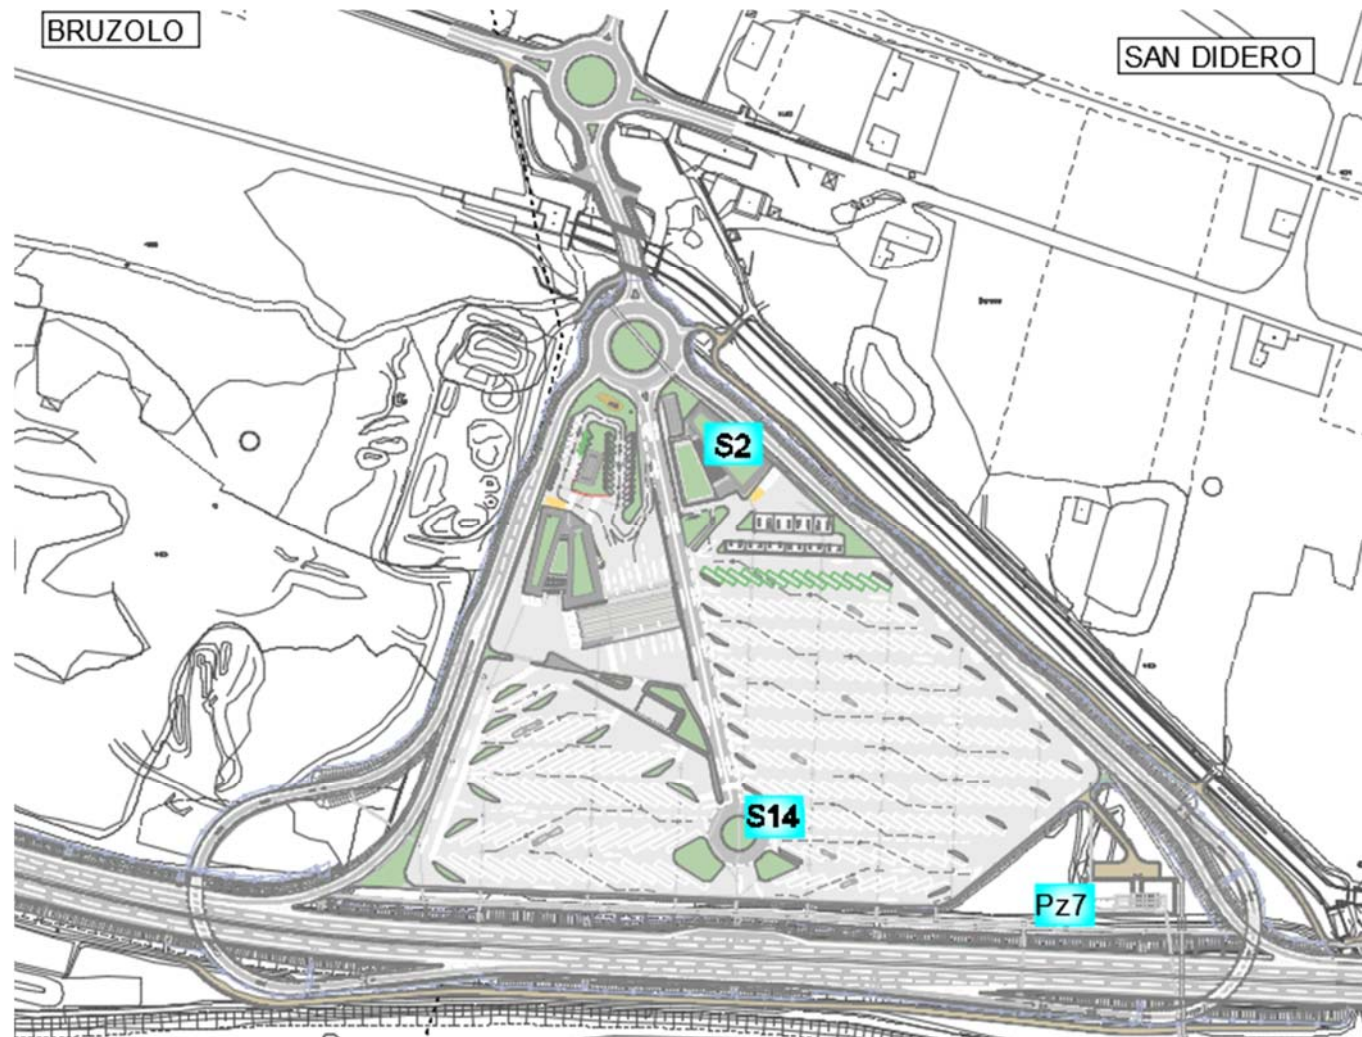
Localizzazione dei piezometri esistenti nell'area con sovrapposizione del layout di progetto
